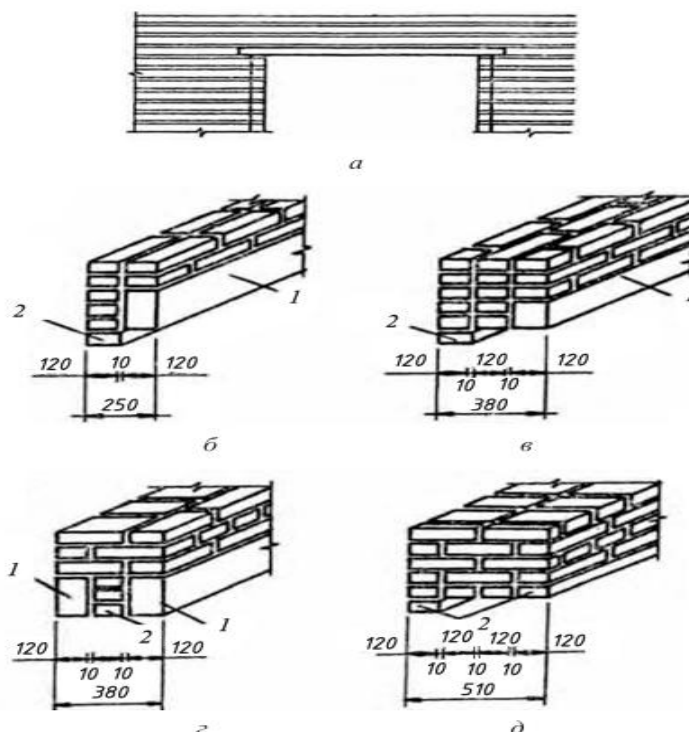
Железобетонные перемычки (размеры в мм): а — общий вид; б, в — наружные стены толщиной 25 и 38 см; г — наружная и внутренняя стена толщиной 38 см; д — наружная стена толщиной 51 см: 1 — несущая перемычка; 2 — ненесущая перемычка.
